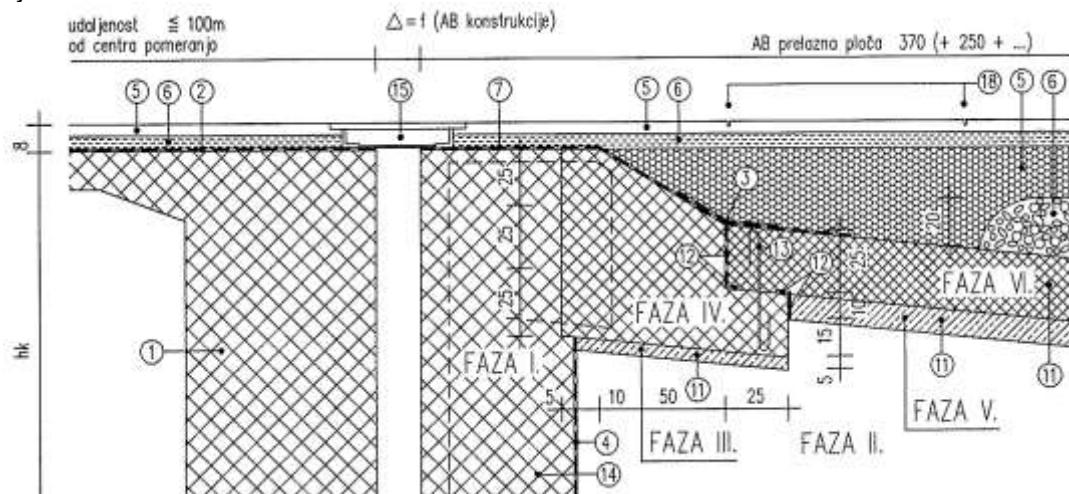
Detalj naleganja i vrha prelazne ploče kod okvirnih AB konstrukcija kada je dužina rasponske konstrukcije 50 – 80 m
